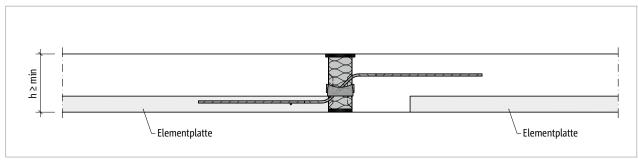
Schöck Isokorb® T Typ QL: Elementdecke mit eingesetzten Schöck Isokorb®
